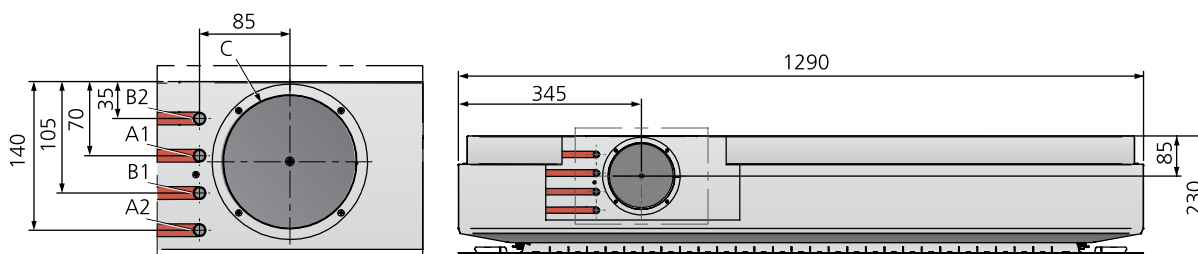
ADAPT Parasol EX 1290, вид сбоку
